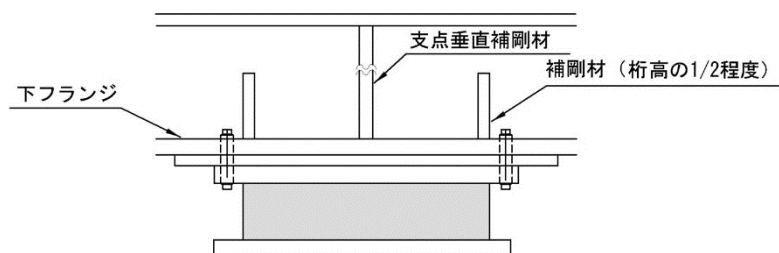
垂直補剛材による支承上の鋼橋腹板の補強例 (道示Ⅴ編 図-解 12.5.1)
